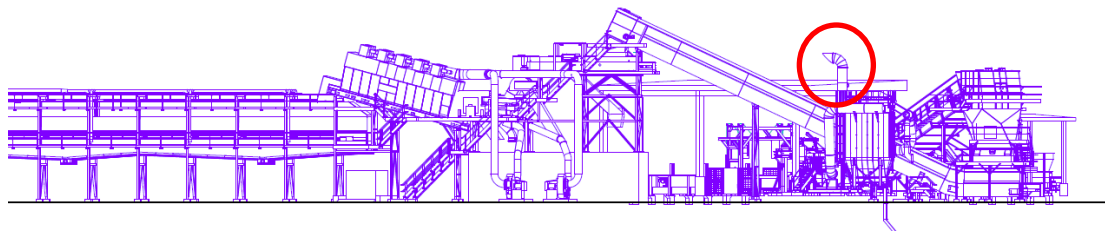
Detailausschnitt Trockenbereich mit Schornstein (roter Kreis).
